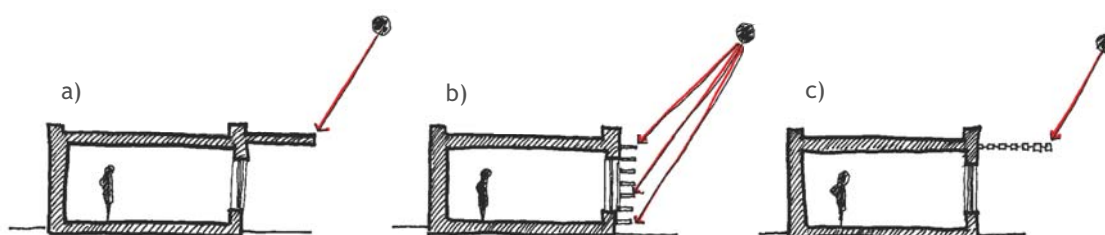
Sistemas solares passivos em fachadas orientadas a sul:
